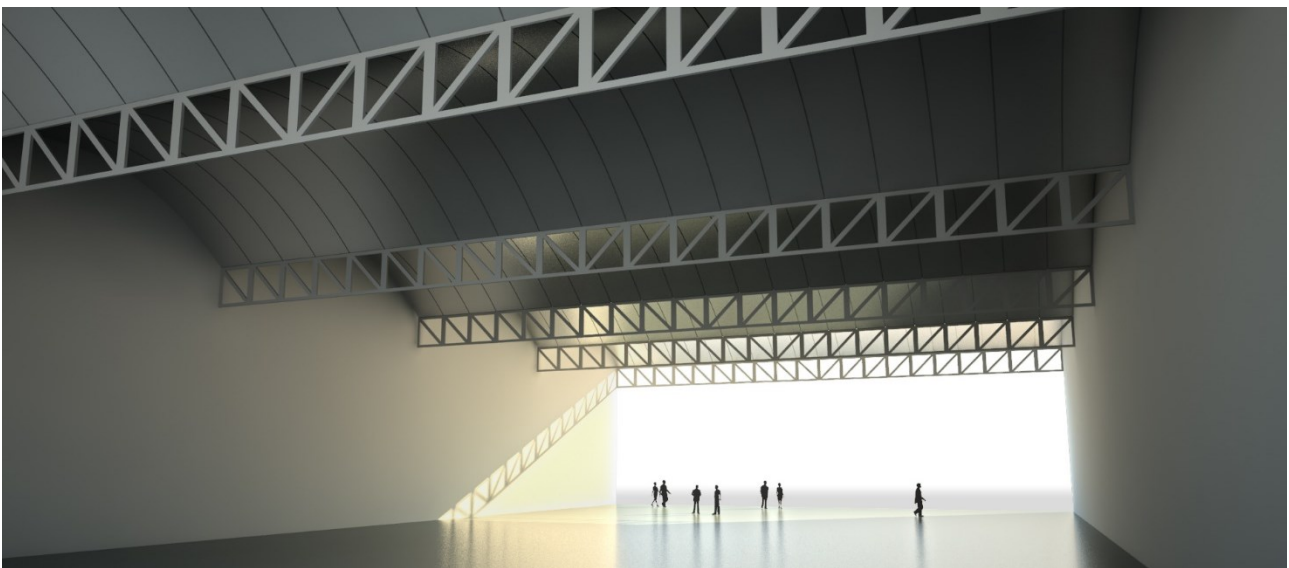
Halle, die einachsig gekrümmte Elemente und Fachwerkträger kombiniert [8]
